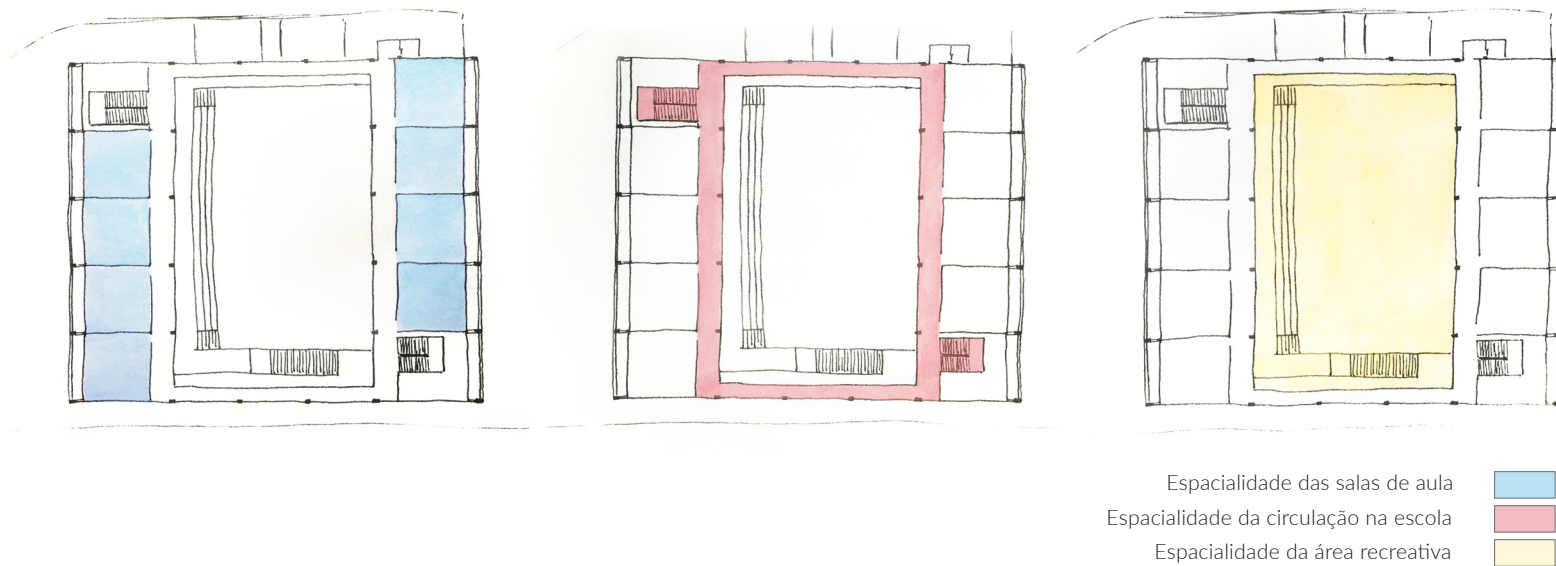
; Fig. 14 e Fig. 15 - Planta baixa esquemática da Escola de Ensino Fundamental FDE Campinas
